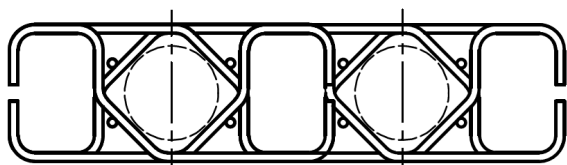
GRAVIDUR TUB Bewehrungselemente
